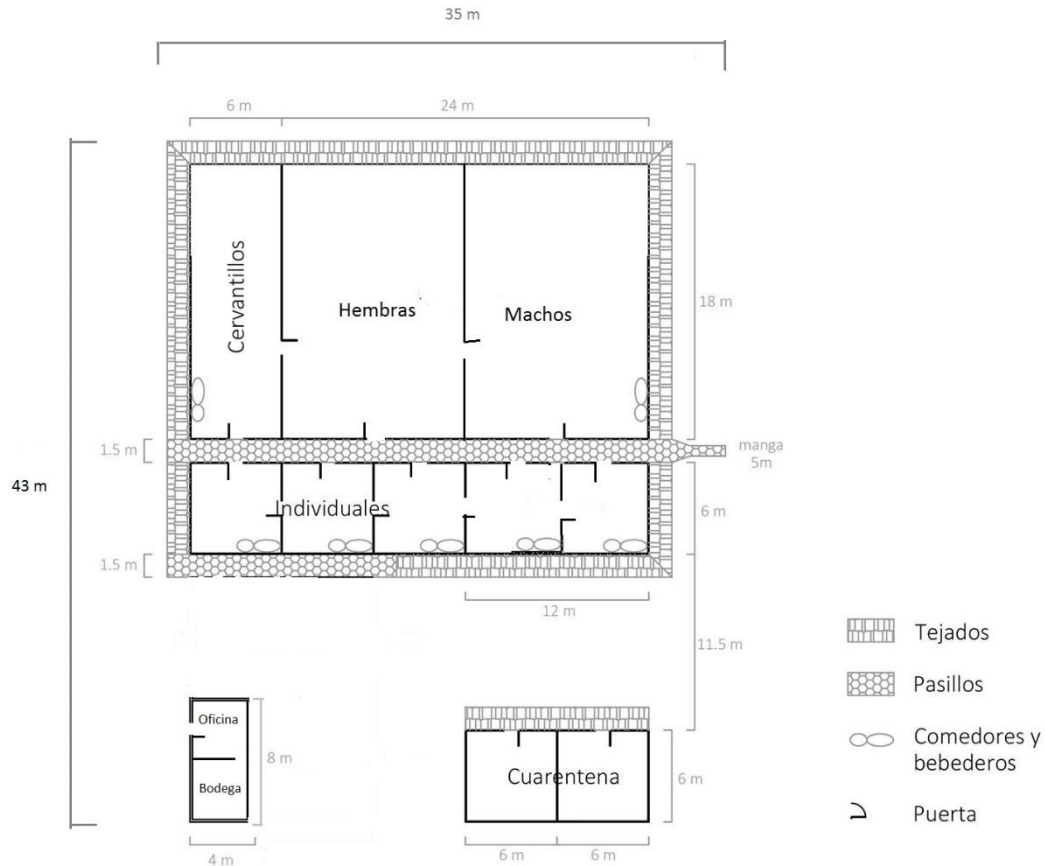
Plano del encierro para los venados. Elaboración de Elizabeth Díaz.
